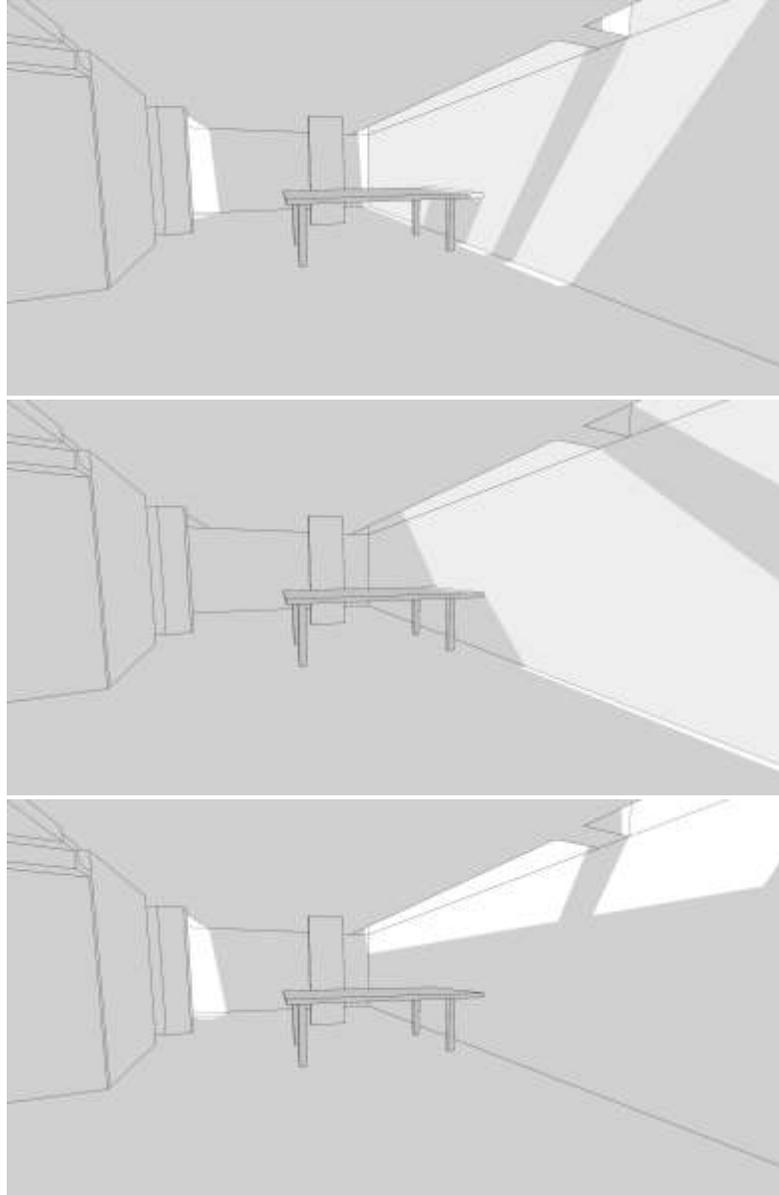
, FIGURA 134 Y FIGURA 135. Volumetría con soleamiento interior planta baja, vista desde la sala.
